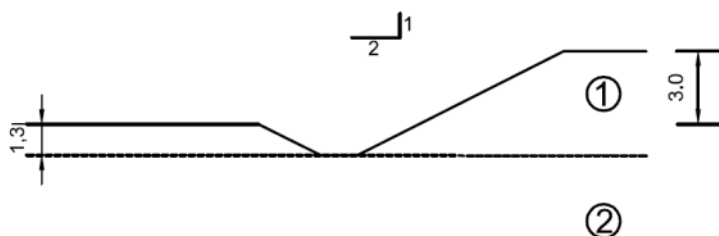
Sezione tipo per la verifica di stabilità della situazione provvisoria in fase di costruzione
